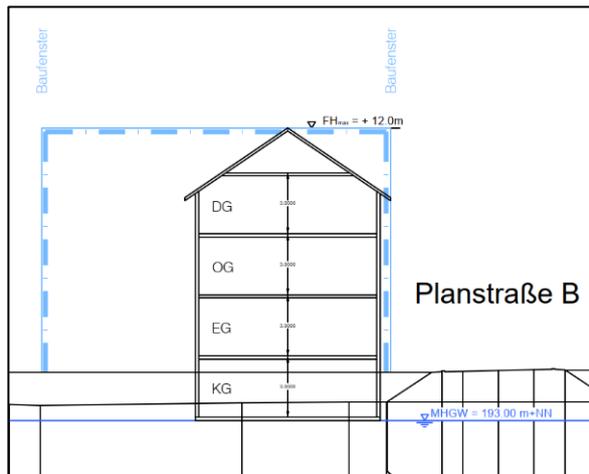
Schemaschnitt mögliche Festsetzungen, Grundwasserstände und geplantes Geländeniveau
